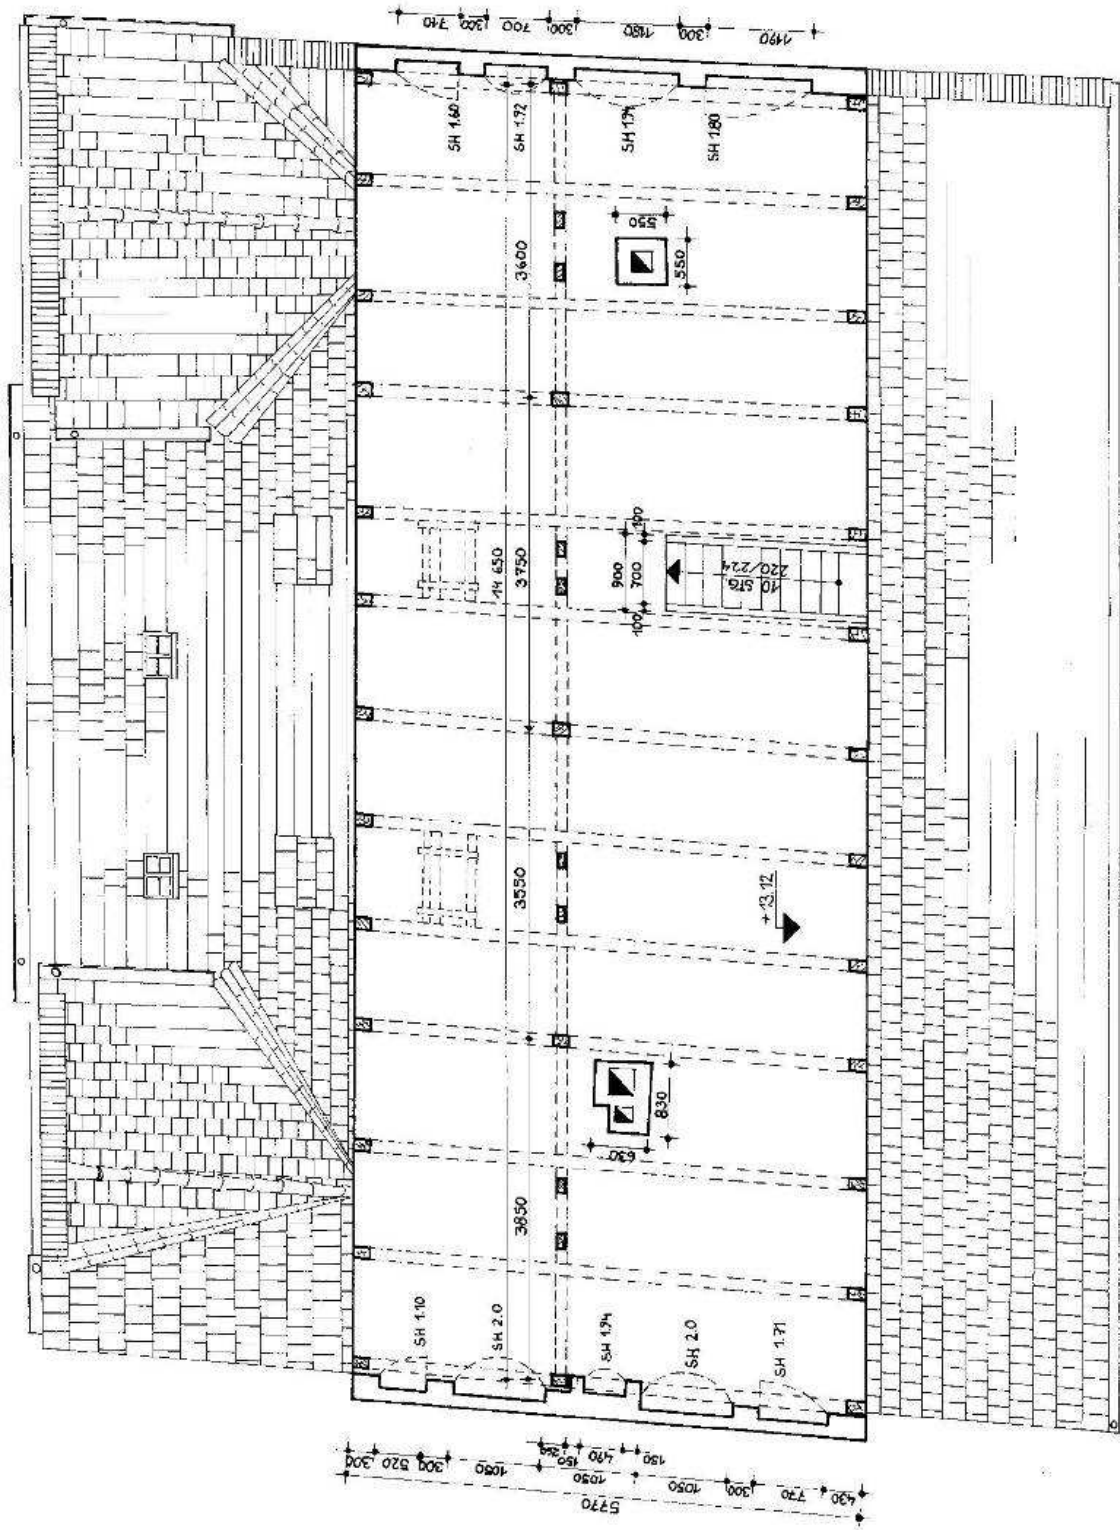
Webergasse 1, Grundriss Spitzboden Vermessung
